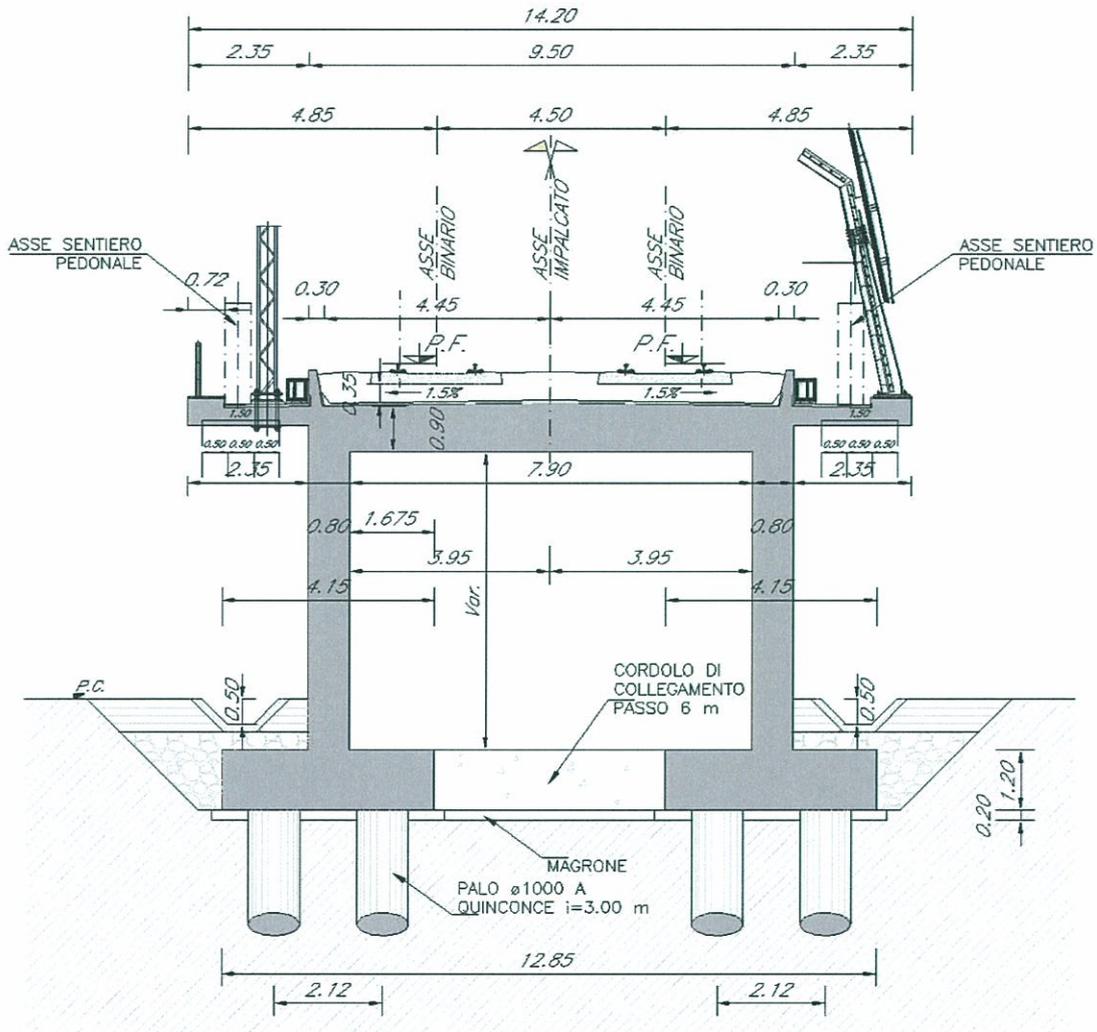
Sezione trasversale dello scatolare a doppio binario.
